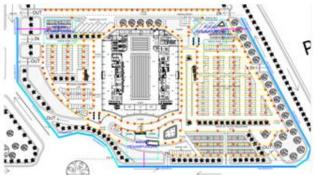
Denah Layout plan. Sumber: data pribadi
